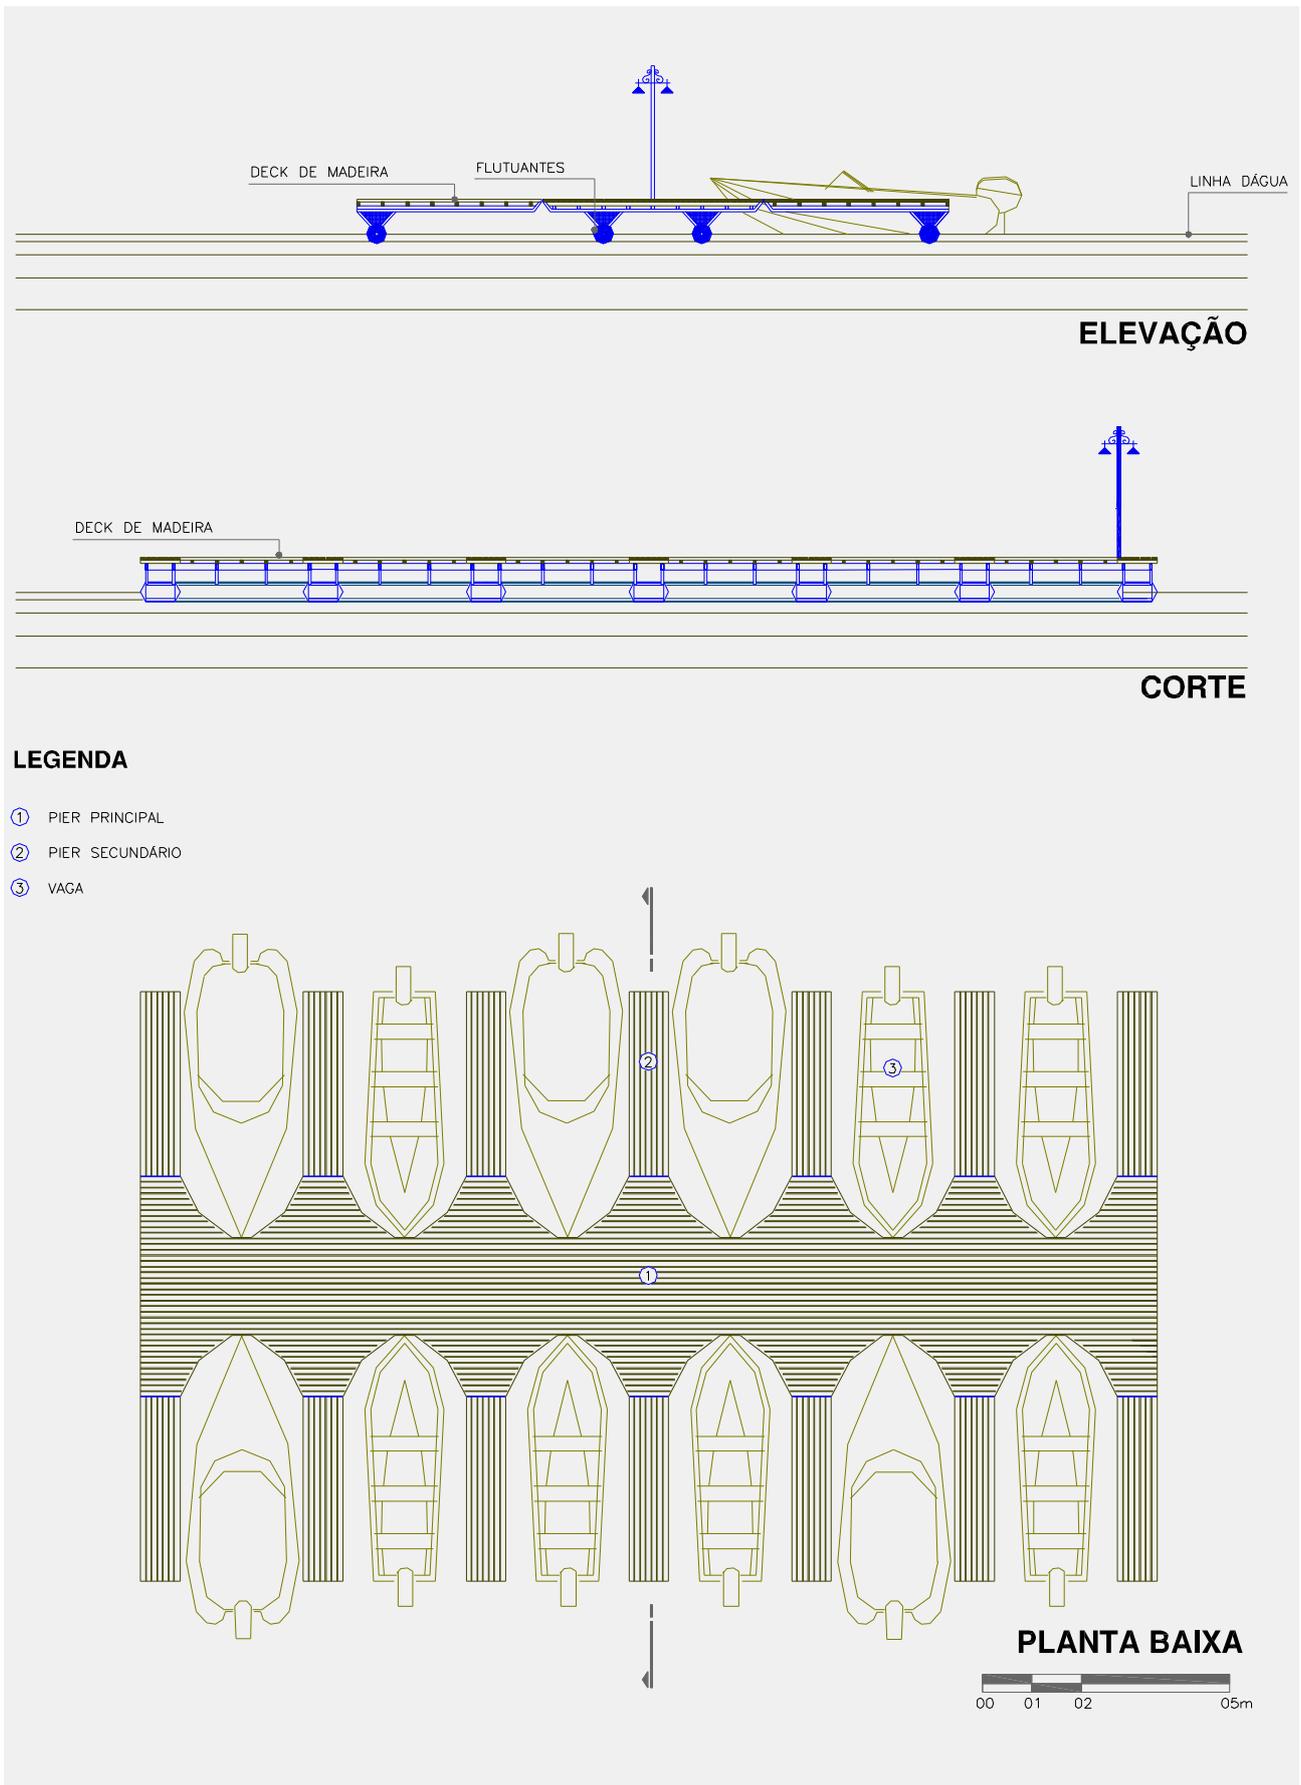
PLATAFORMA FLUTUANTE: ATRACADOURO (VISTA, CORTE E PLANTA BAIXA)
